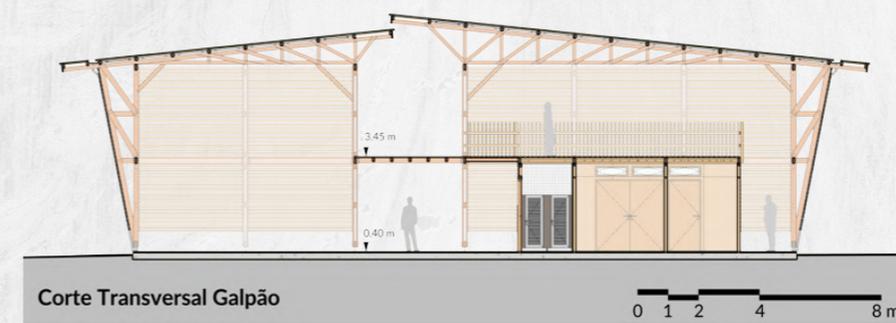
Corte transversal do bloco dos galpões de construção.
